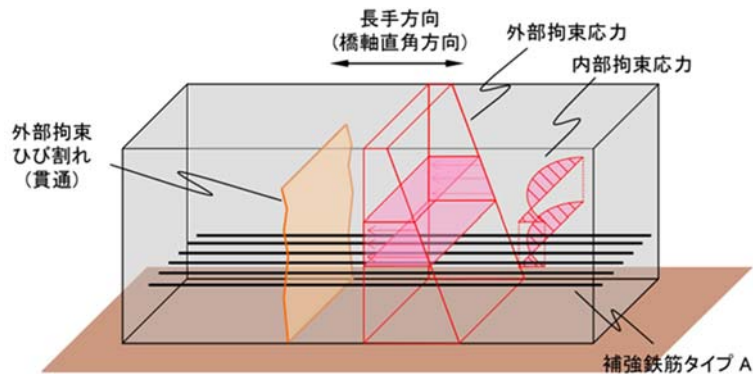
ひび割れ発生方向と抵抗鉄筋概要図(補強鉄筋タイプA)
